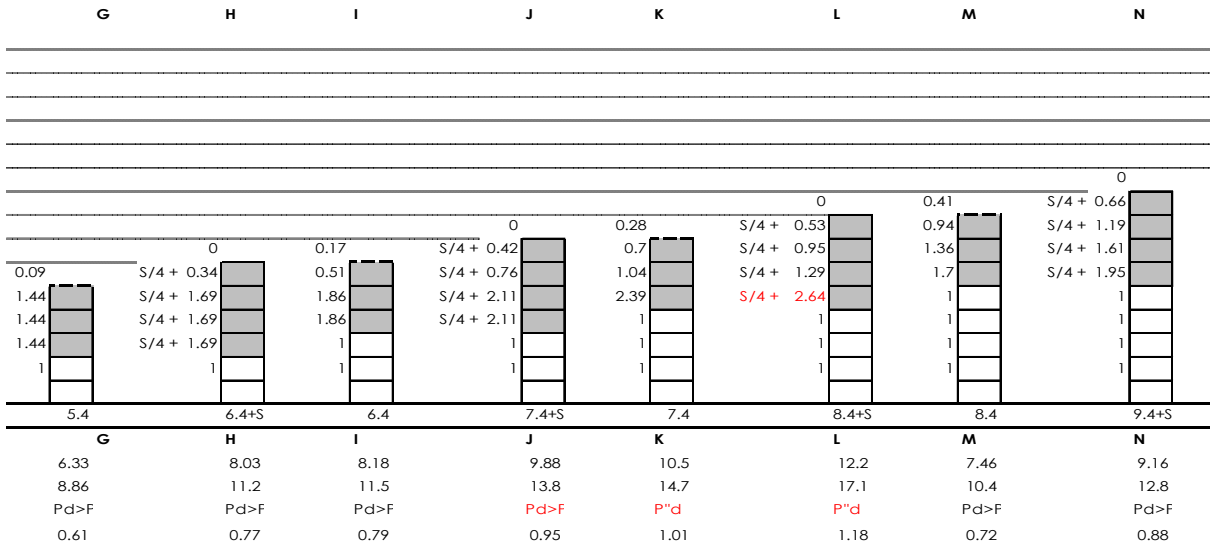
Proceso Constructivo. 4 Cimbras forjados de Losa Reticular. 2/4
